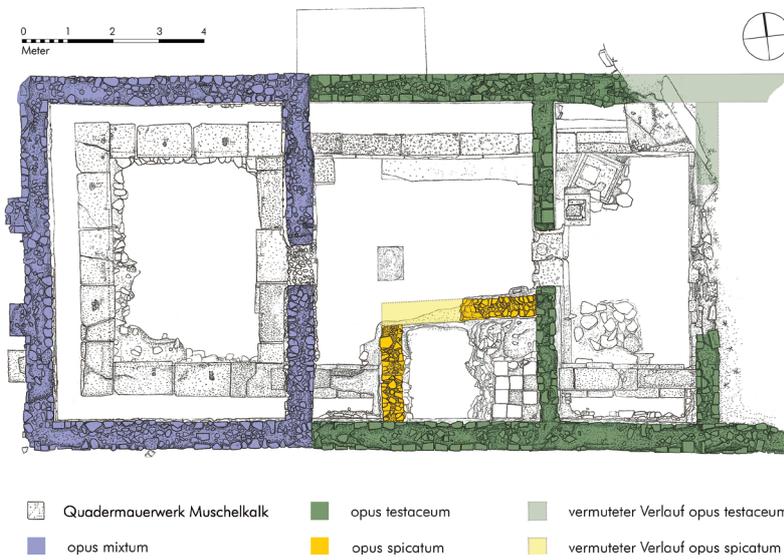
Mauerwerkskartierung Grundriss mit Mauerwerksarten.
